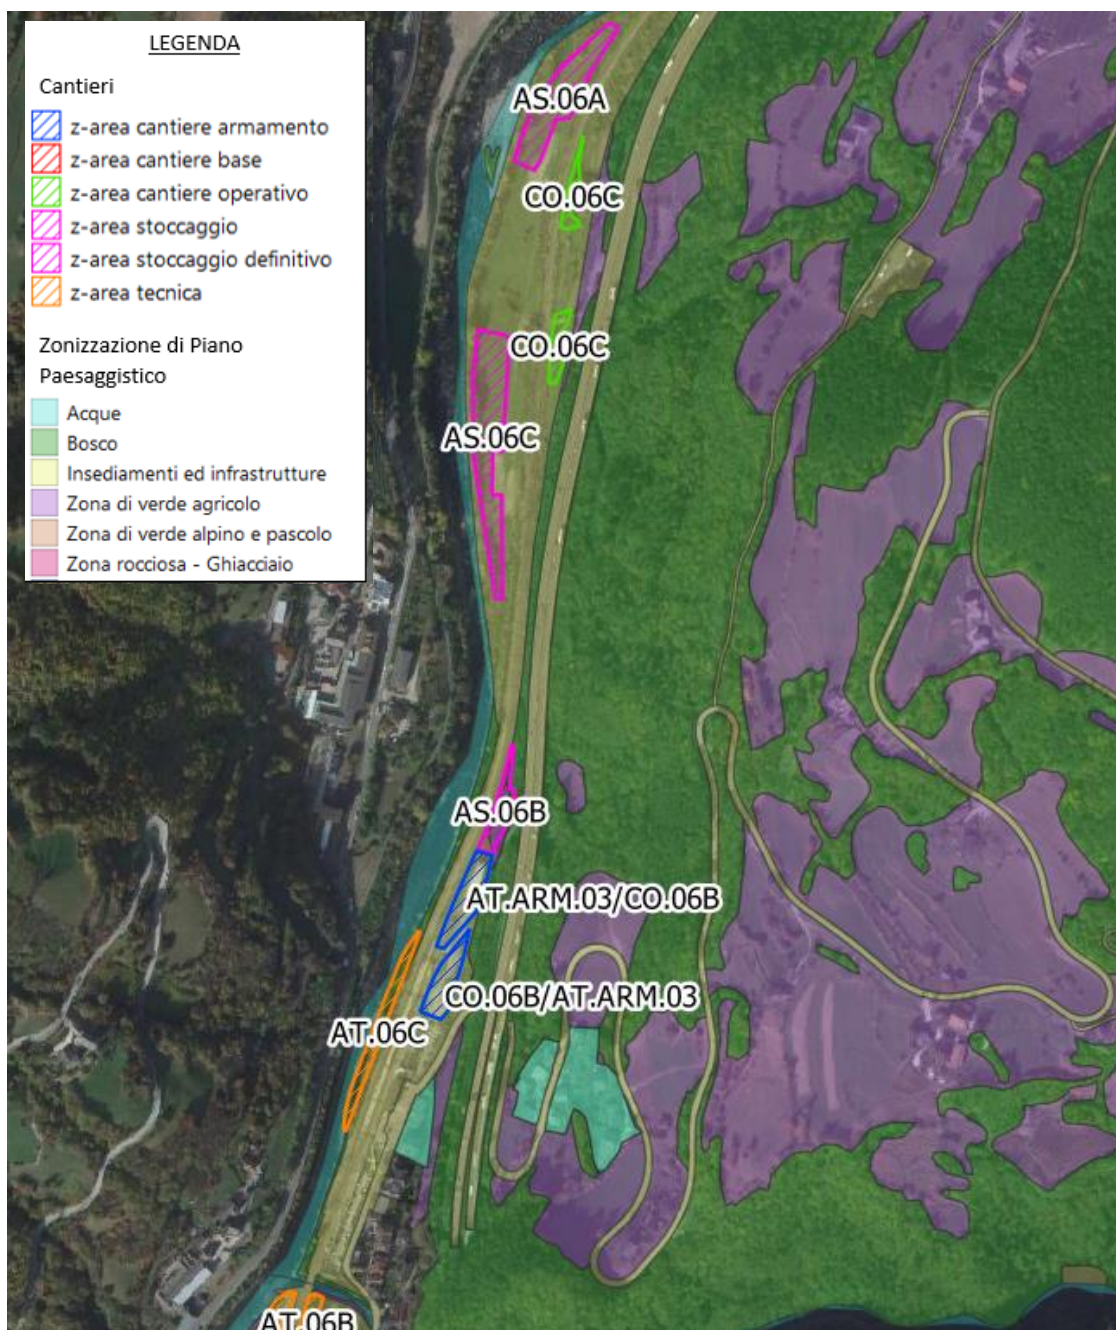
Individuazione delle aree di cantiere dell'ambito Ponte Gardena con relativa zonizzazione di Piano – Progetto Esecutivo
